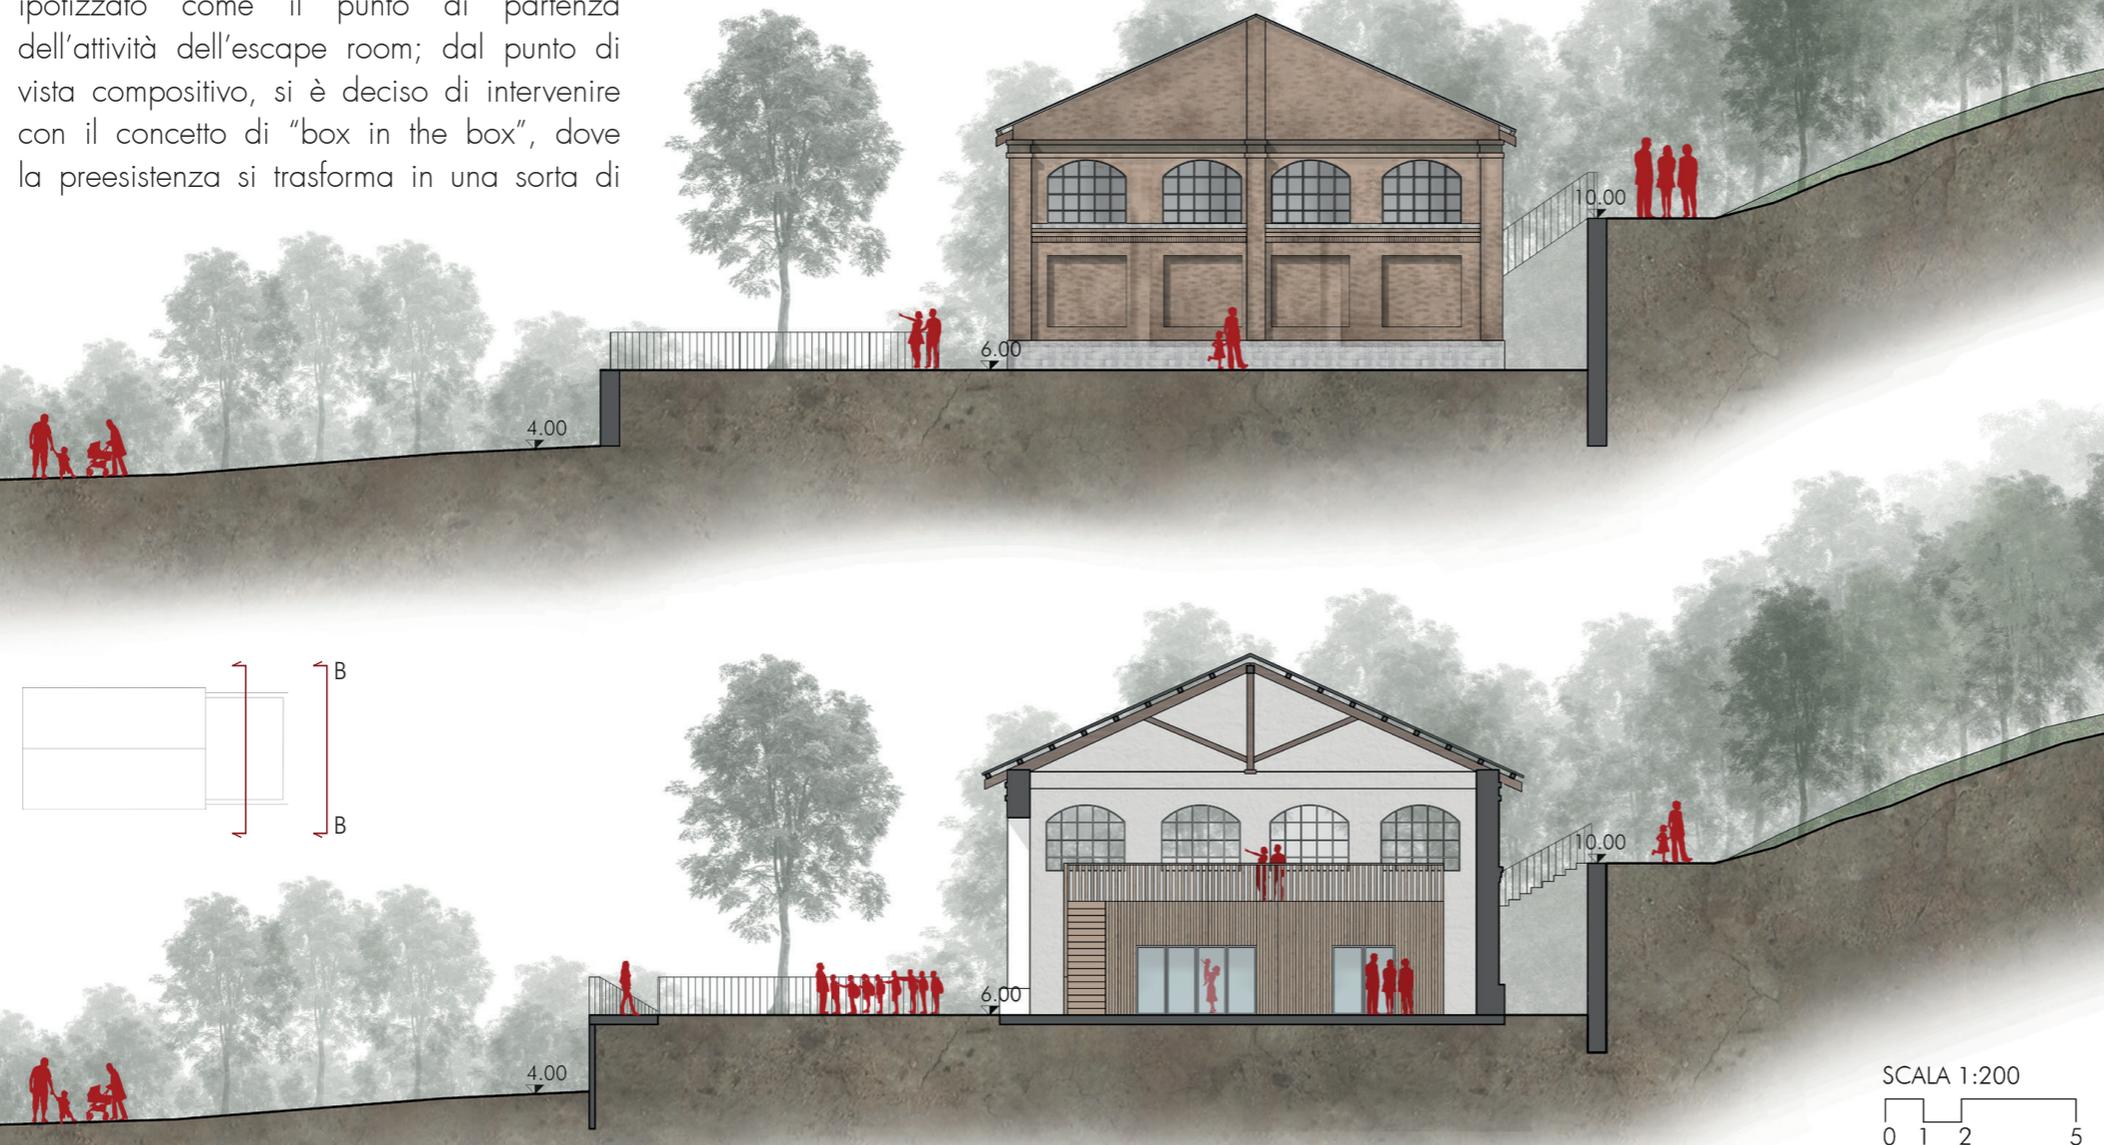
Prospetto sud-est e sezione BB del polo centrale dell'escape room, elaborazione delle autrici
